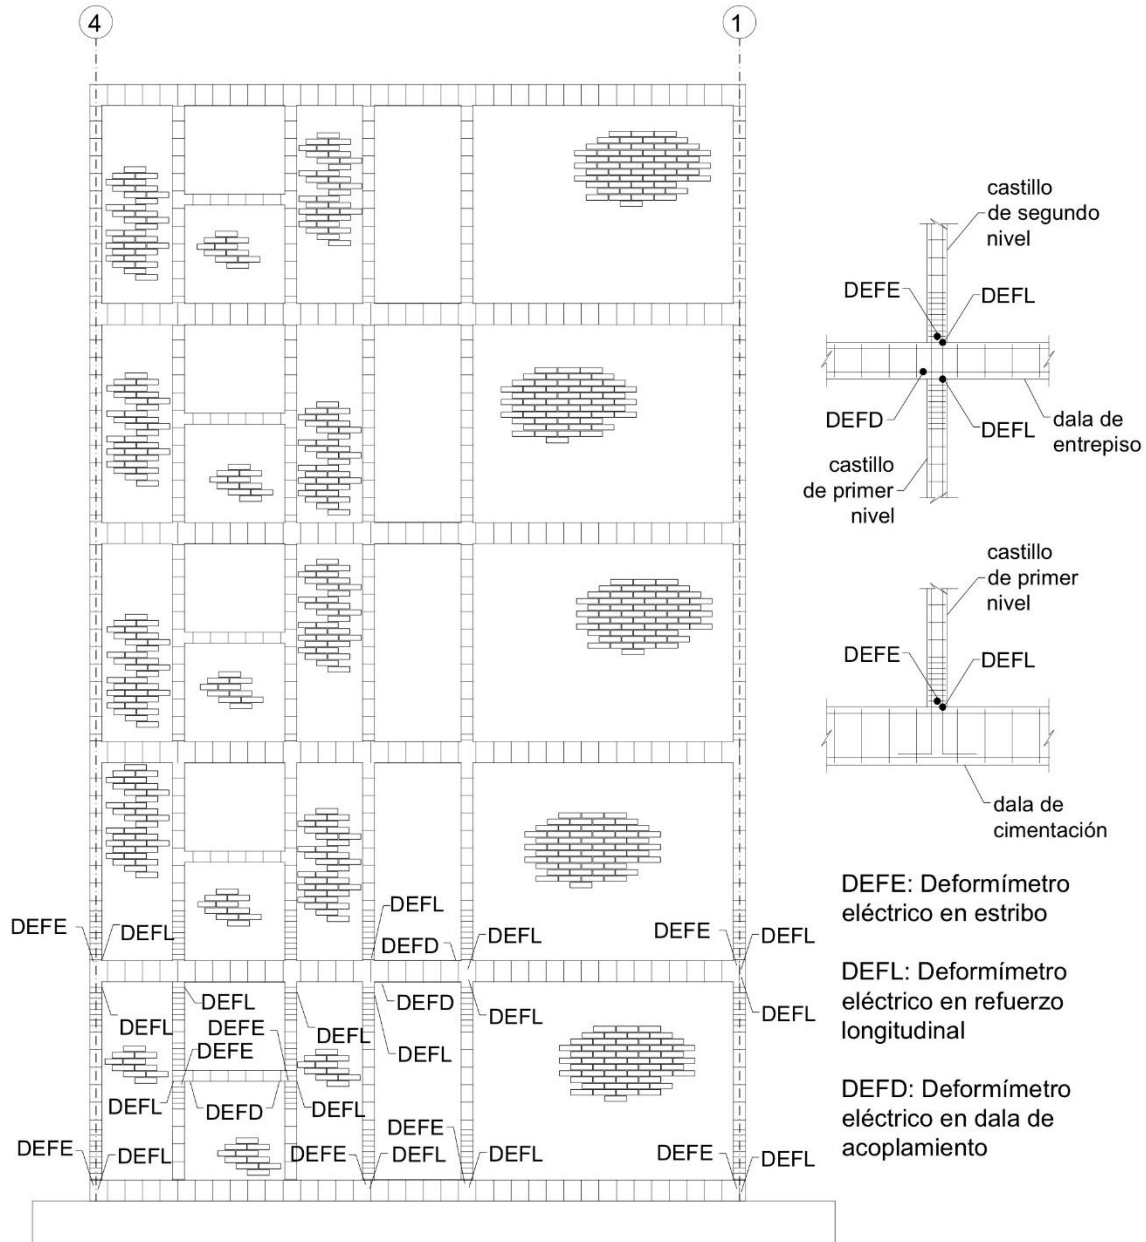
Distribución de deformímetros eléctricos en fachada del eje C
